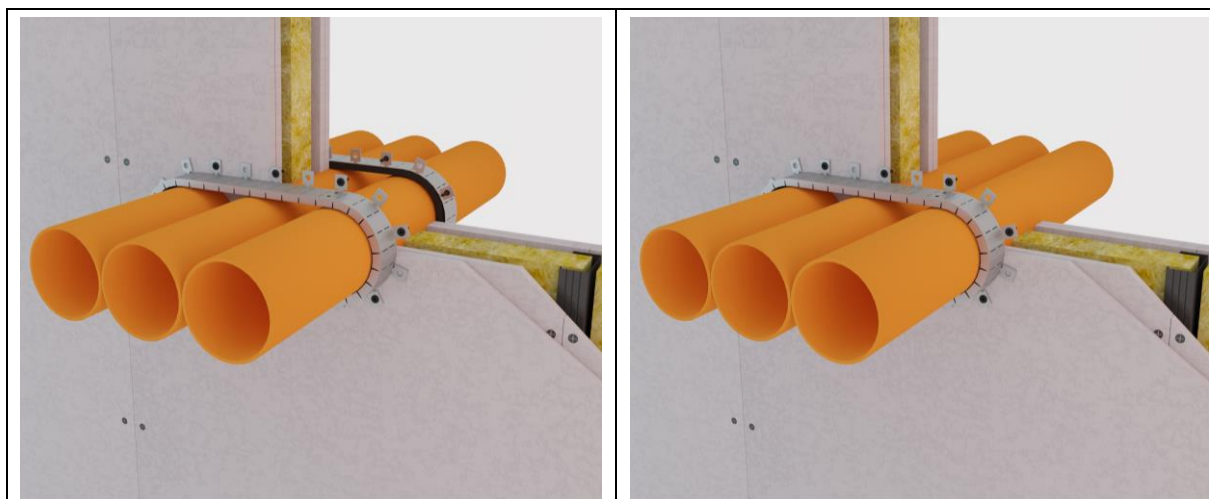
Ejemplo de sellado de penetración de un conjunto de tuberías de plástico en una pared flexible: (a) a ambos lados de la pared, (b) en el lado expuesto únicamente.
